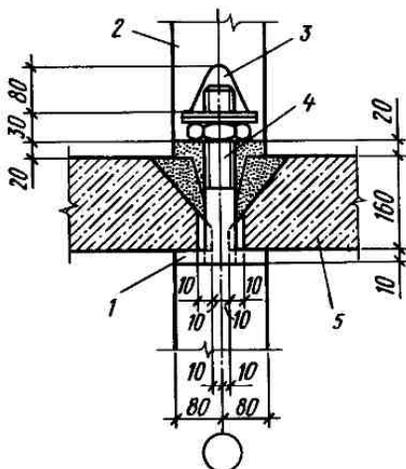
Конструкция соединения панелей внутренних стен и перекрытий:
